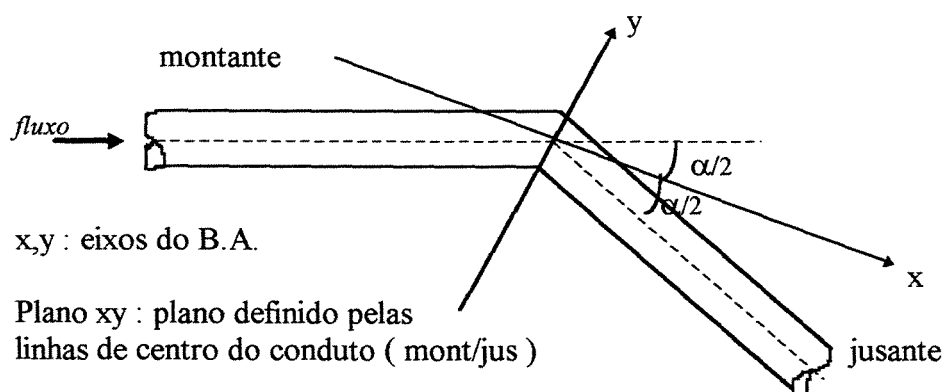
Vista em planta de um ponto de mudança de direção do conduto (implantação de um B.A)
